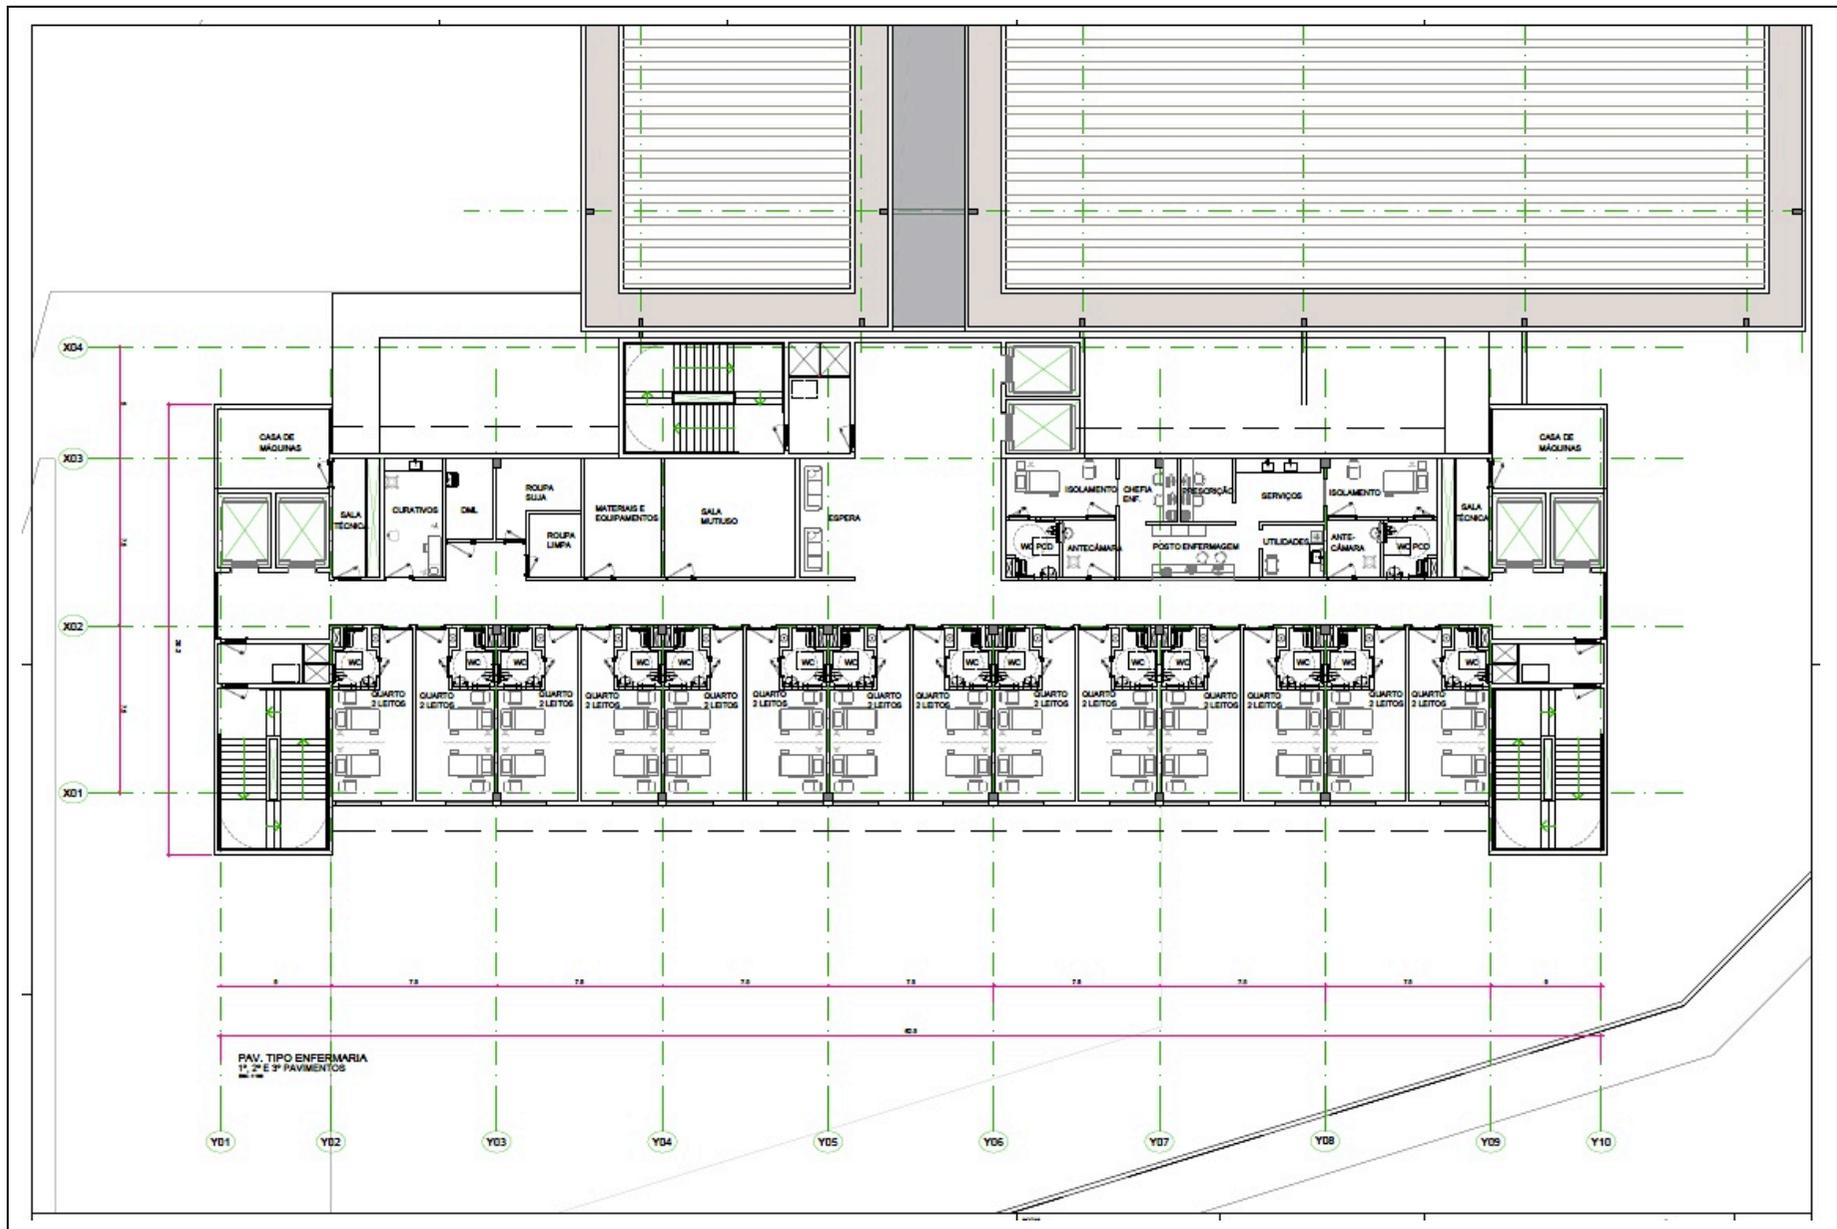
Hospital e Maternidade Mário Degni. Planta tipo enfermaria do 1º, 2º e 3º pavimentos. Fonte: SMS.
